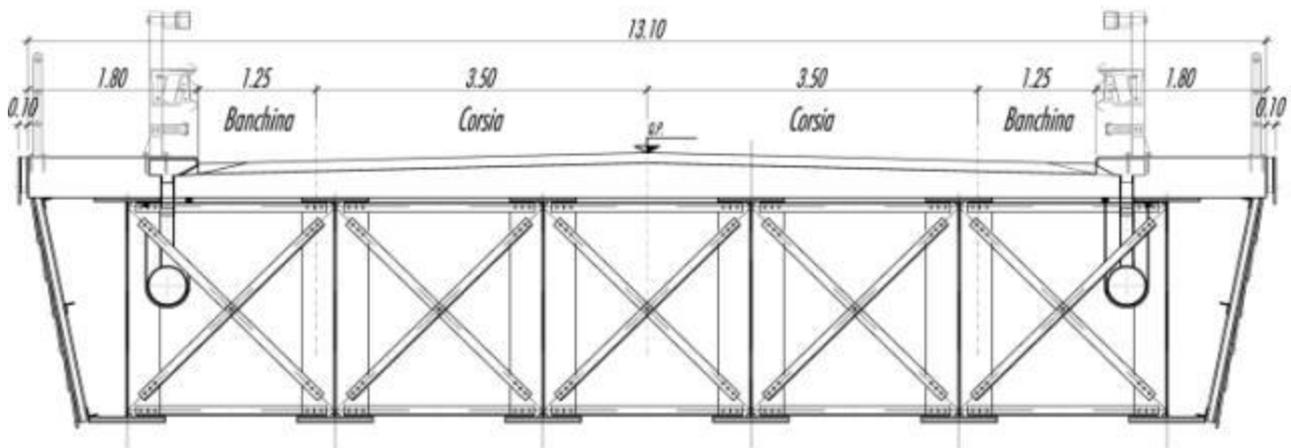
Prospetto del Ponte sul Rio Bigontina (ns. elaborazione da tavola T01VI02STRDI01_A_Sezione longitudinale, prospetto e schema appoggi del progetto definitivo).
